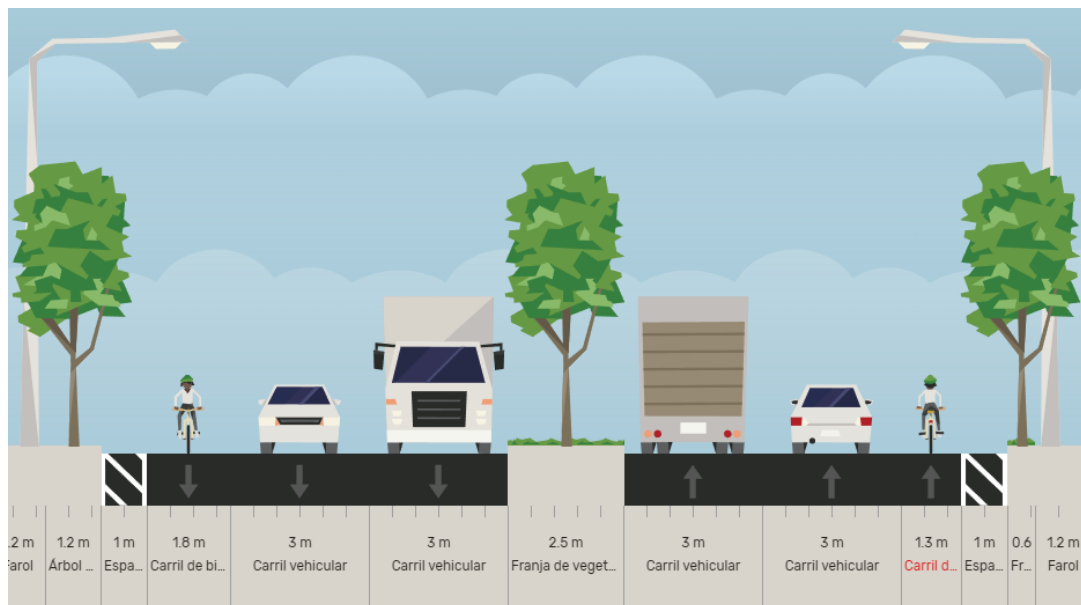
Sección típica – Ciclorruta Malla Central – Propuesta PMMS – Zona Centro
